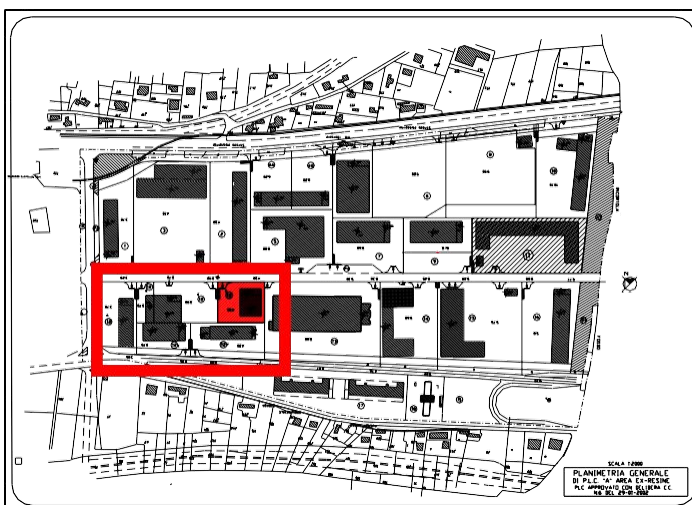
PLC AREA EX RESINE CON STRALCIO LOTTO 12
